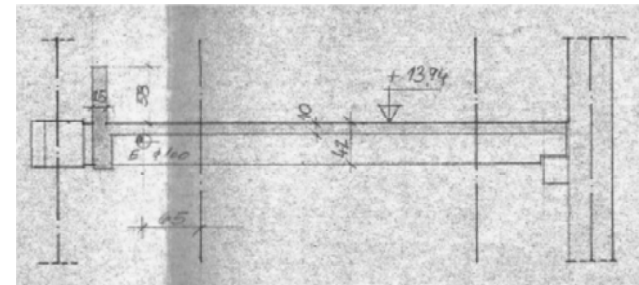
Schnitt durch Deckensystem (links Balkenkopf, rechts Konsolaufleger am Stahlbetonkern)
